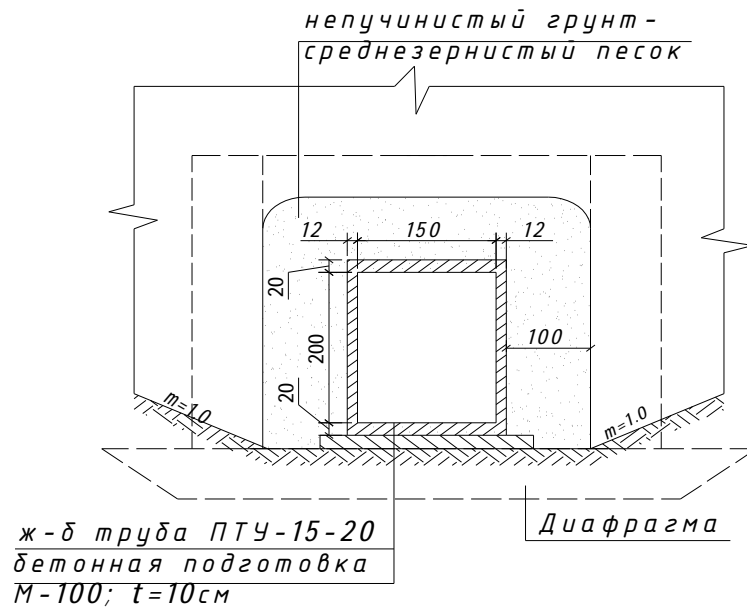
Водоотводящая труба шахтно-башенного водосброса
